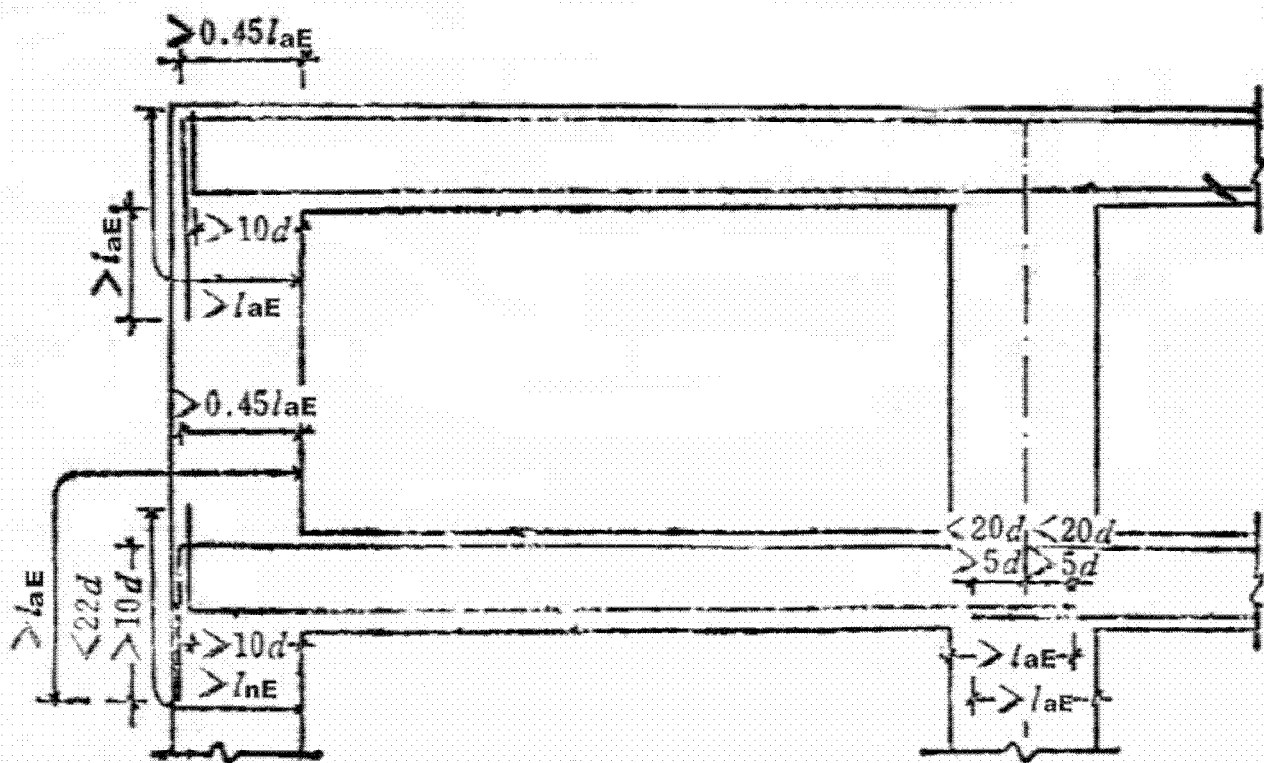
抗震设计框架梁纵向钢筋在节点内的锚固
